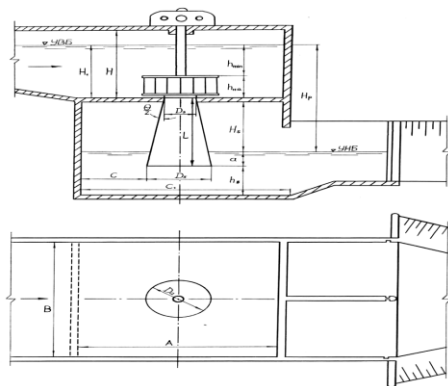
Общая схема компоновки здания малой ГЭС с вертикальной гидротурбиной и прямоосной конической отсасывающей трубой
